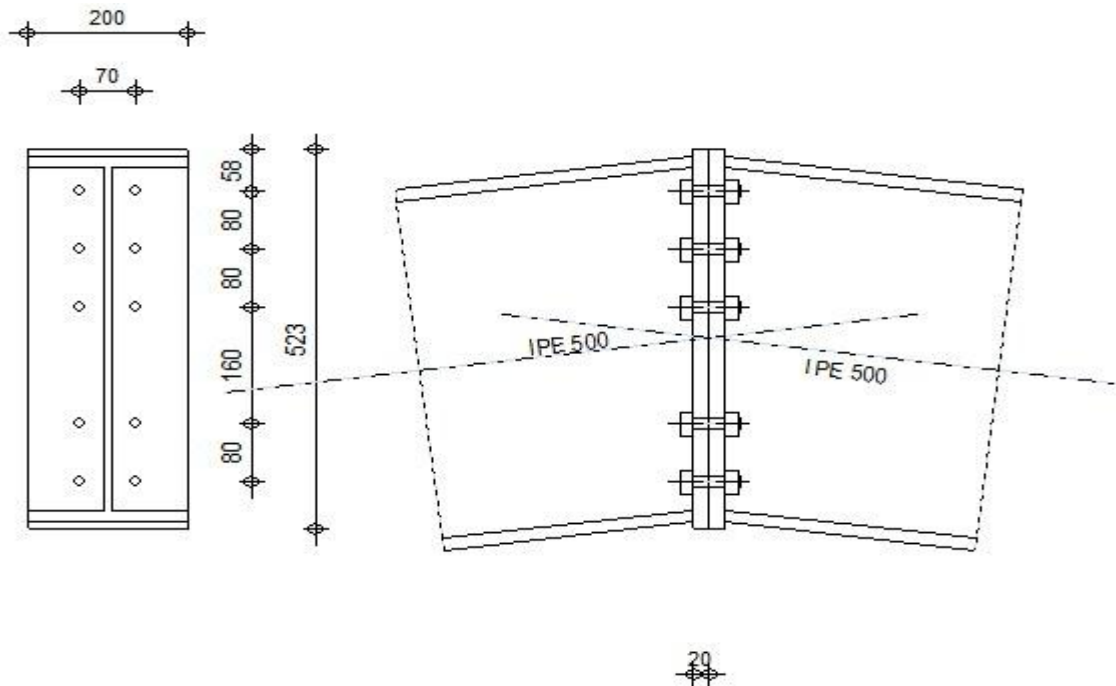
Détail de l'assemblage au niveau de faitage
